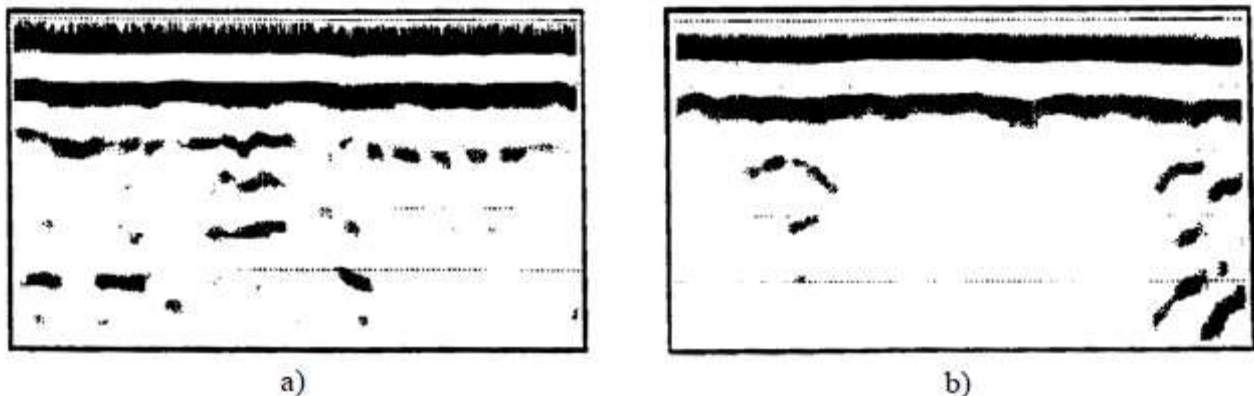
Rilevamento georadar della parete prima (a) e dopo (b) l'iniezione
